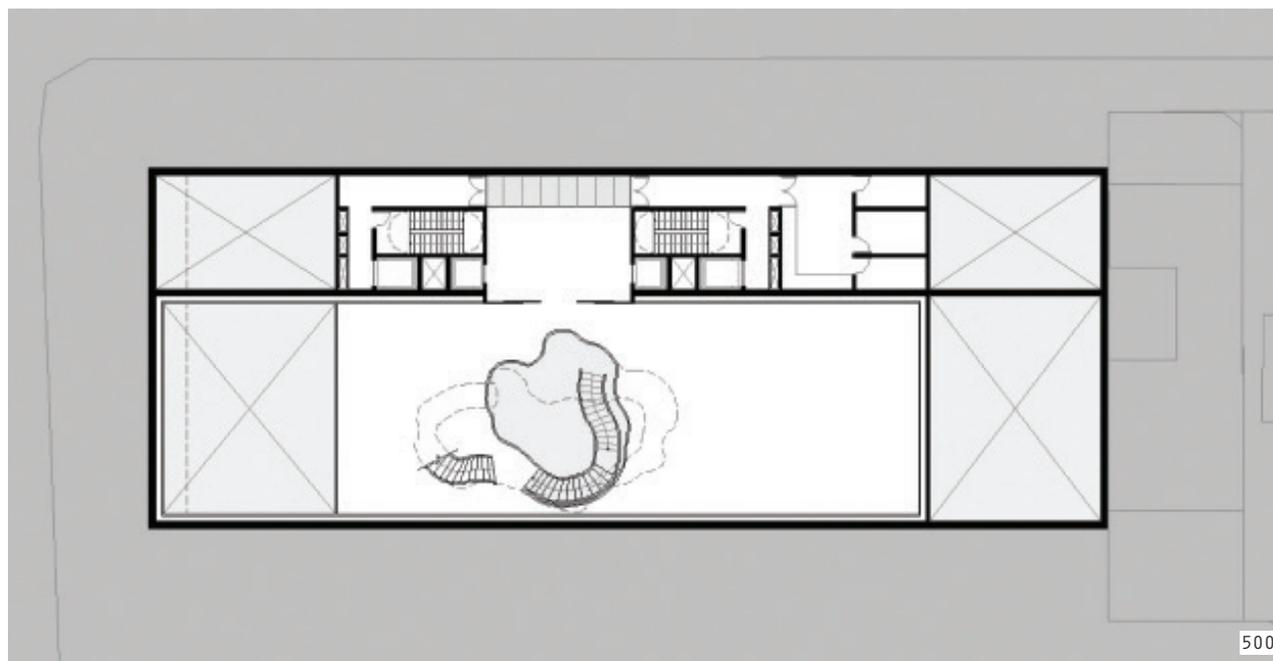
E 496: PLANTA BAIXA; IMAGEM DO INTERIOR;
